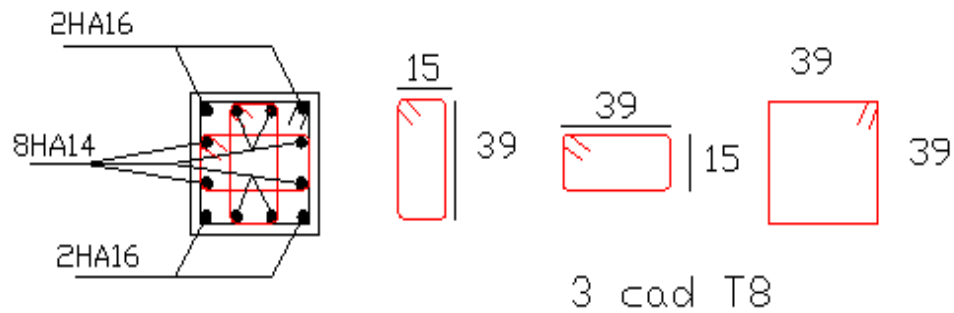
6: Ferrailage Poteau 45 × 45.
